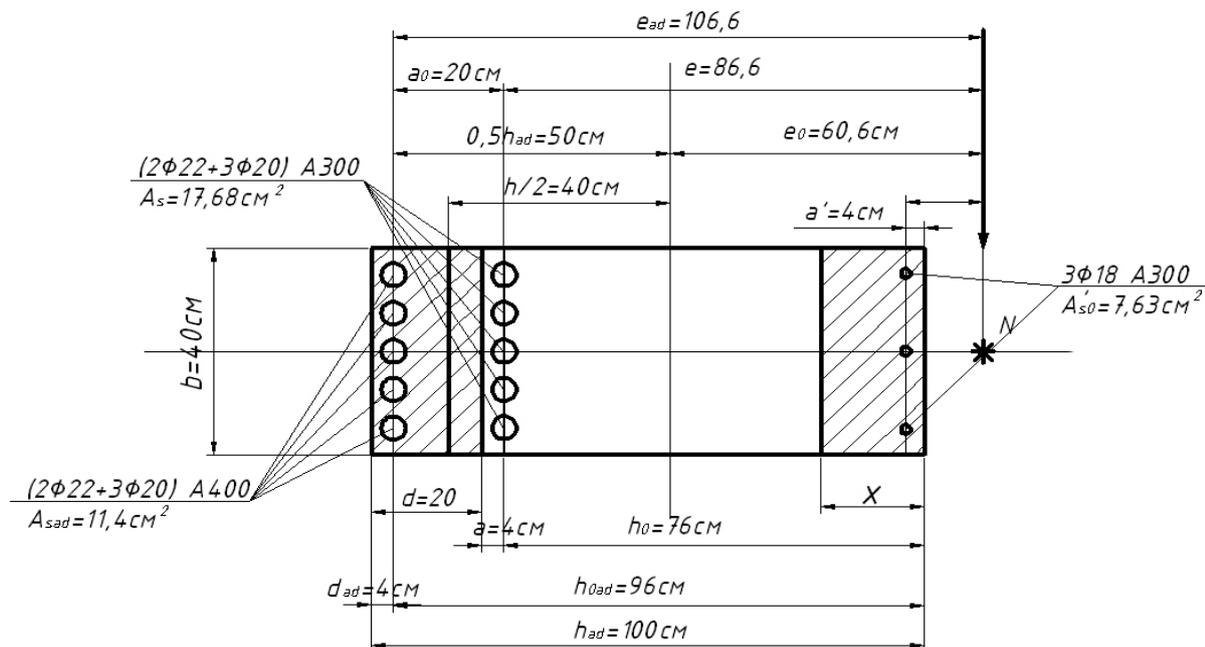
Усиление внецентренно сжатой колонны с большим эксцентриситетом наращиванием со стороны растянутой арматуры
